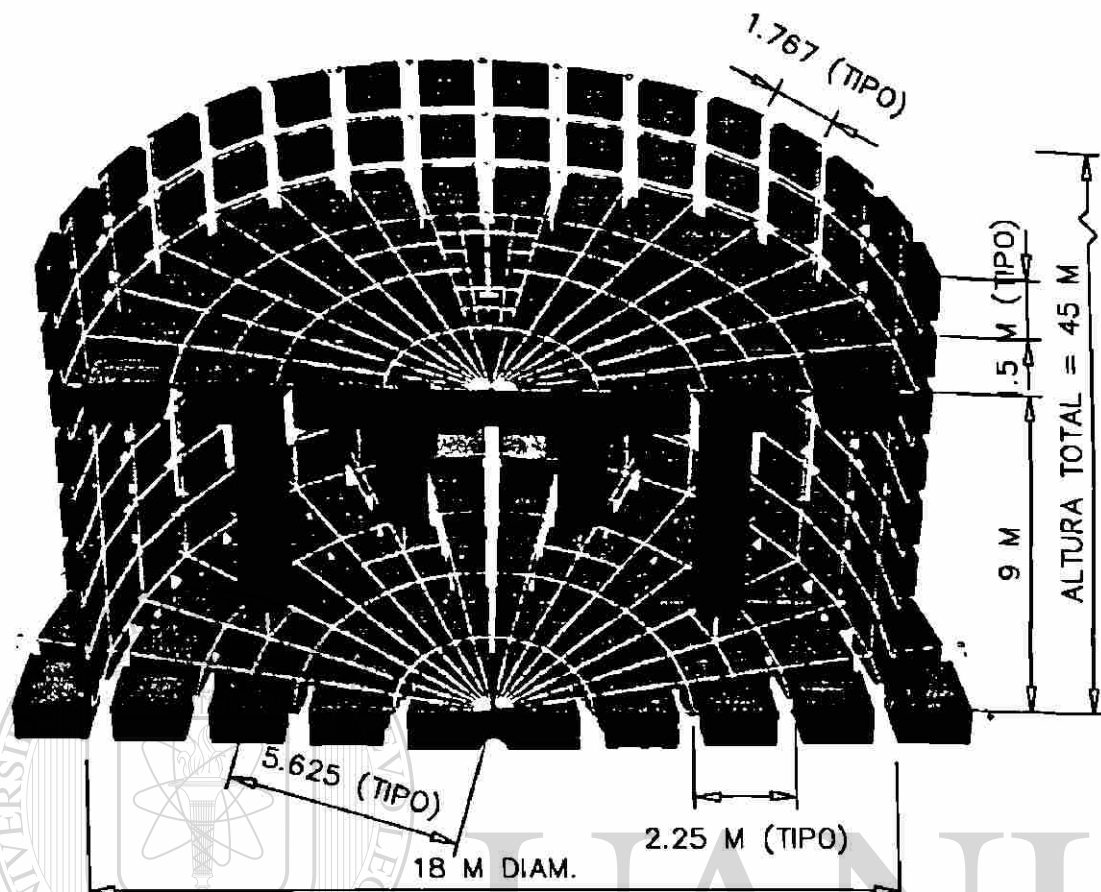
Geometría de medio silo de 18 m diam., $H/D = 2$ y losa de fondo plana.
